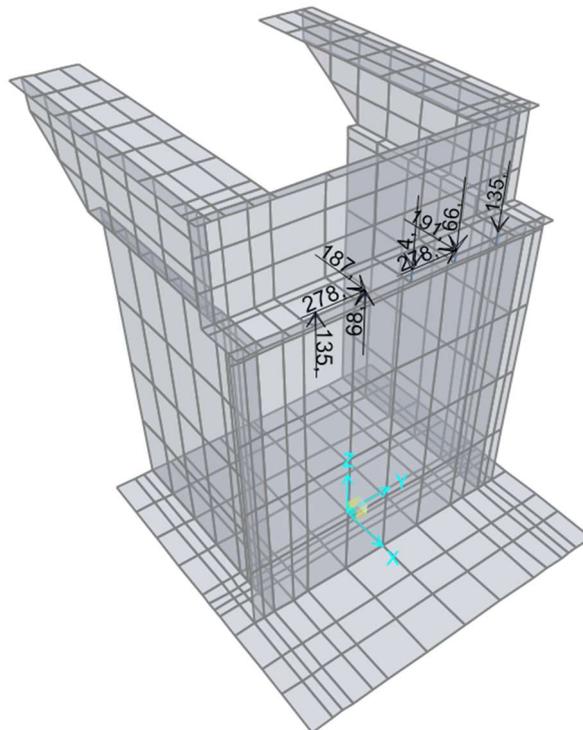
Modello FEM Finale – Vista assonometrica carichi sismici in direzione y trasmessi dall'impalcato su spalla fissa (Imp_sis_Y)
